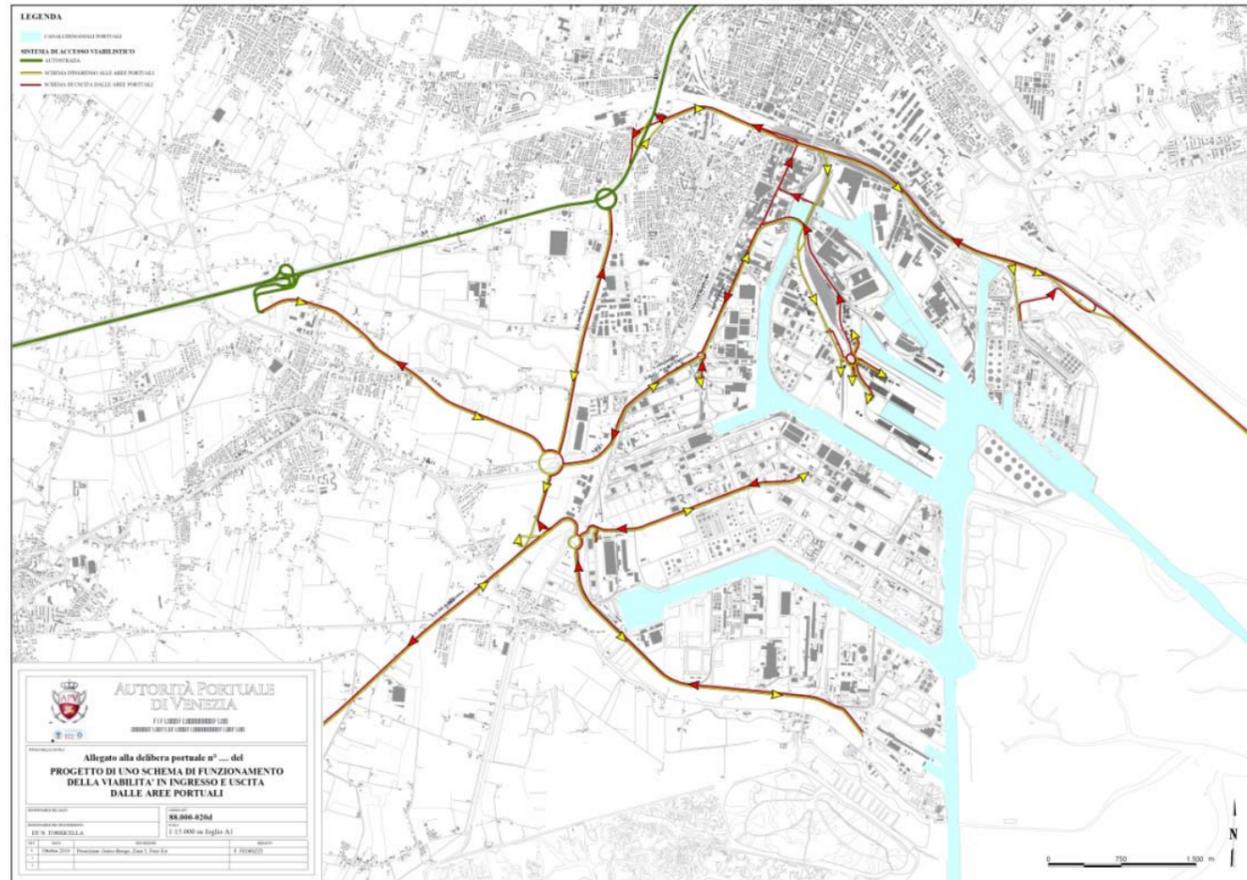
Planimetria della viabilità stradale di accesso/uscita al porto di Venezia.
